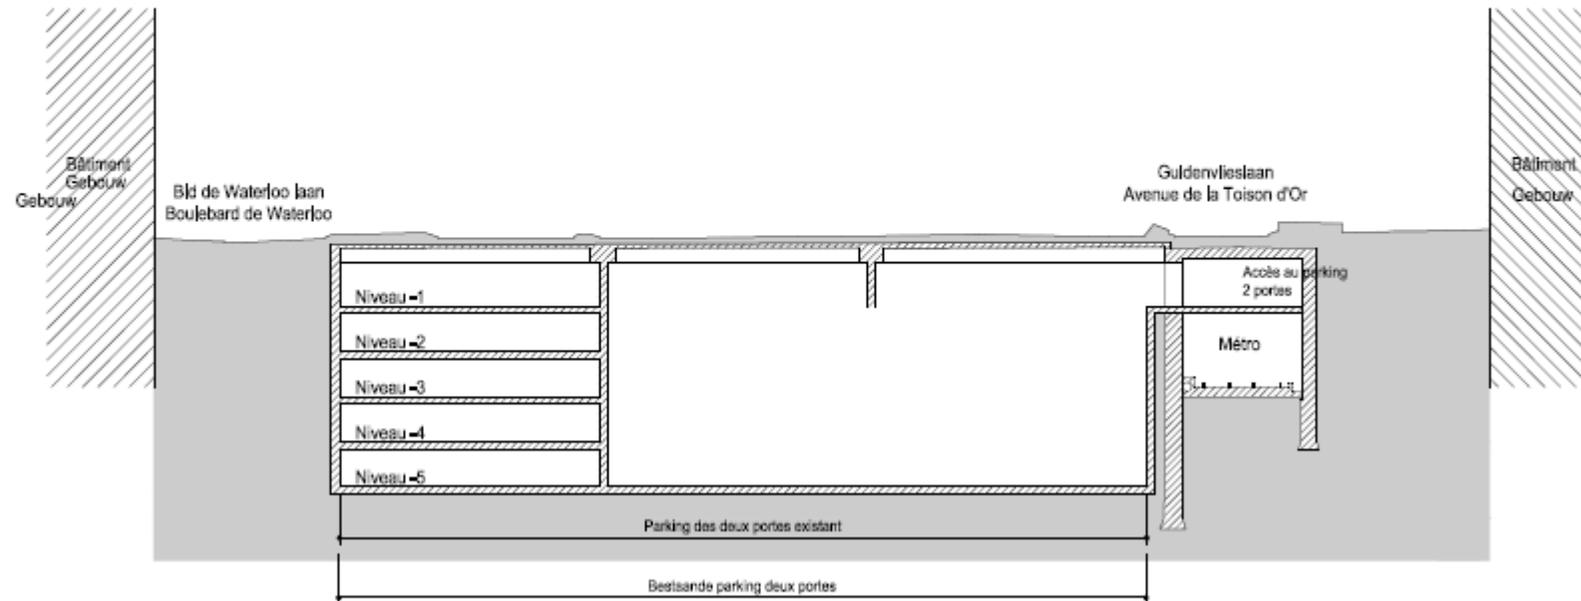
Coupe transversale 5 de la zone du projet dans la situation existante.
